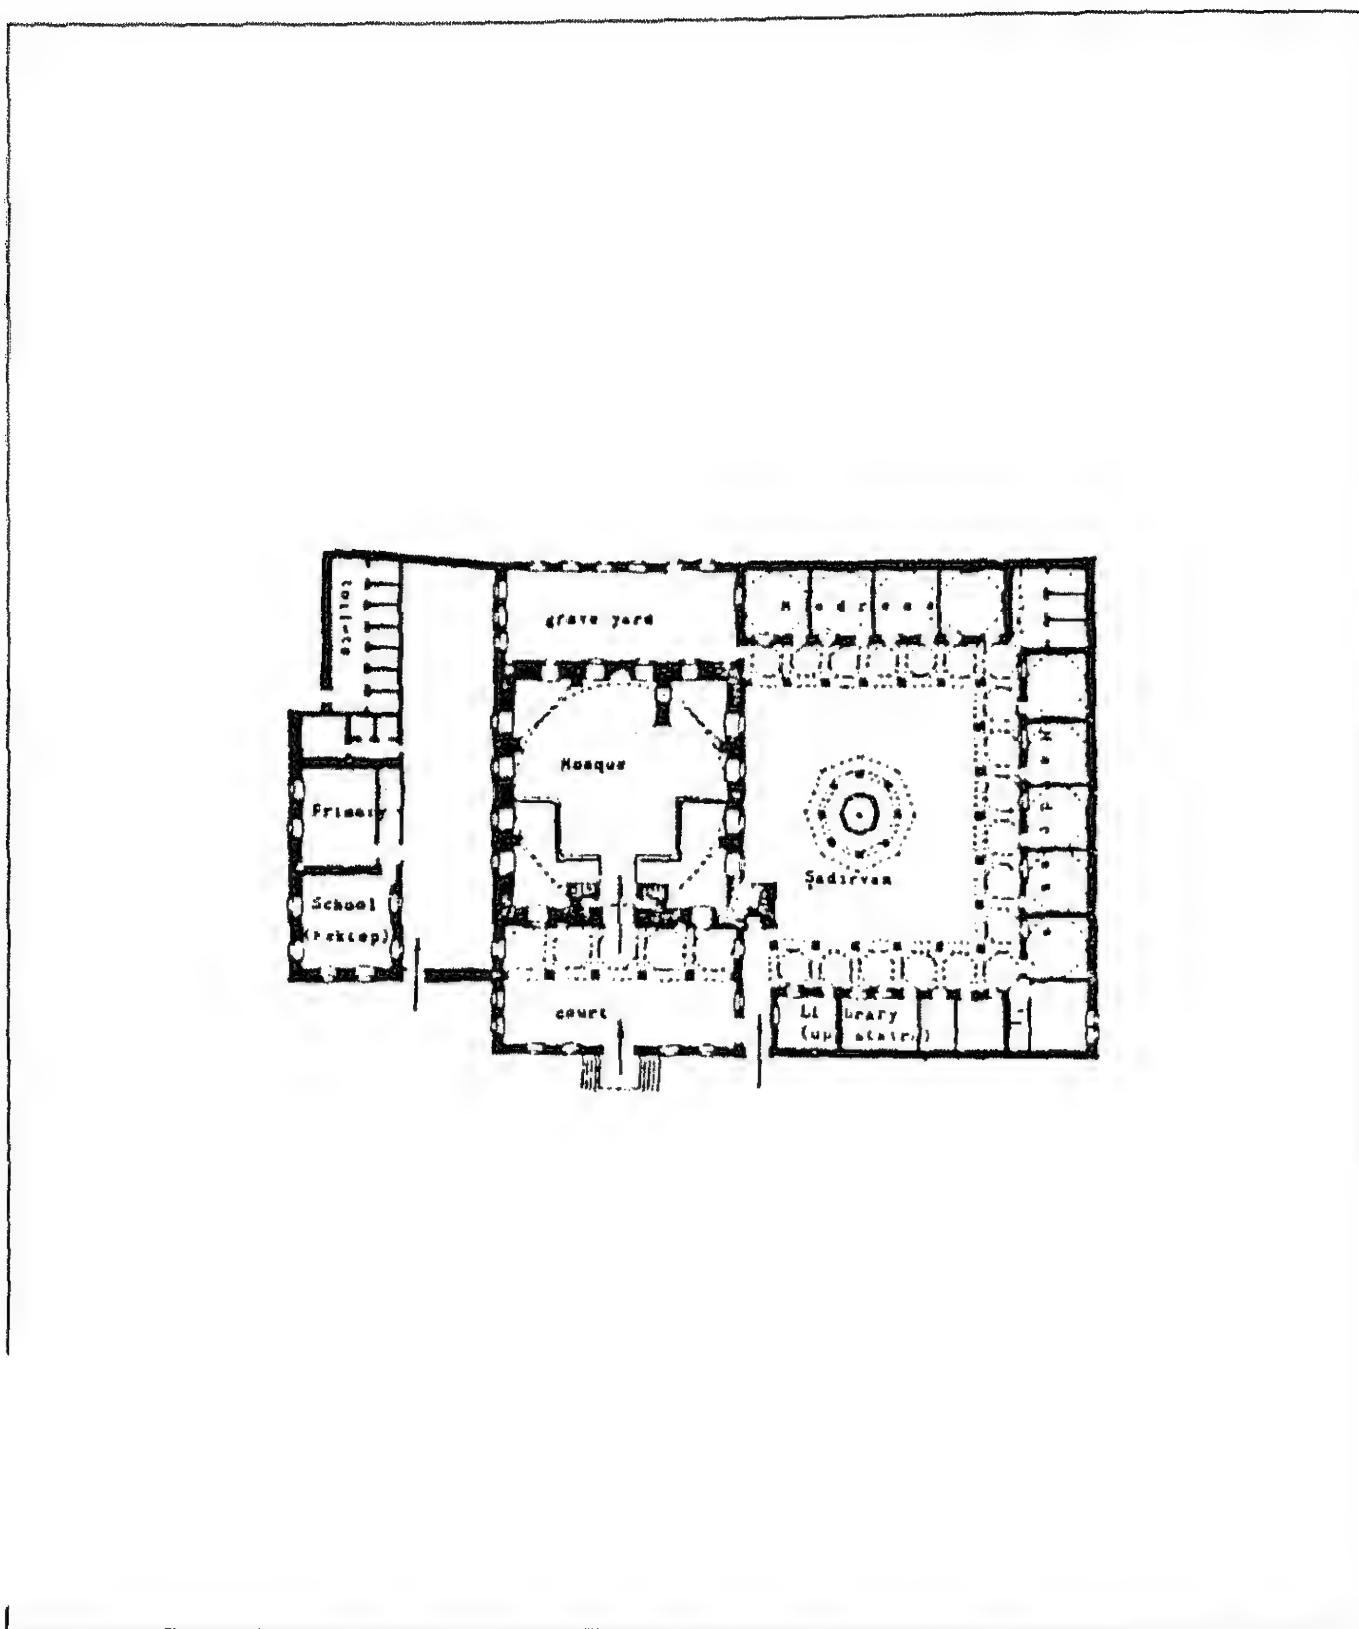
مسقط أفقي لمسجد نور عثمانية في إستانبول (عن : جودوين) .
